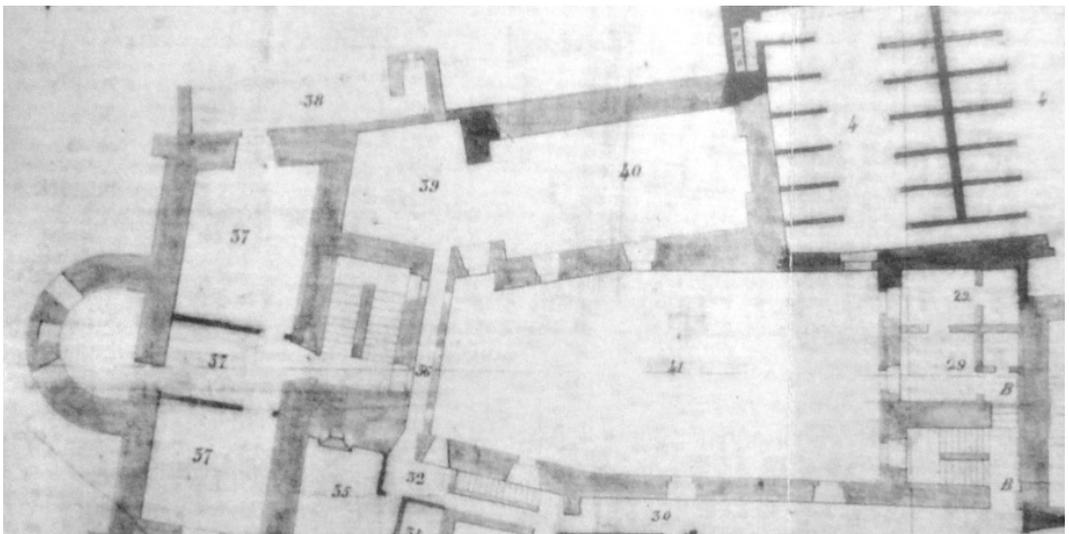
Plano de los Ingenieros Sierra y Cayuela, planta segunda, detalle capilla (Cantalejo San Frutos, 1996: planimetría, proyecto 1).
